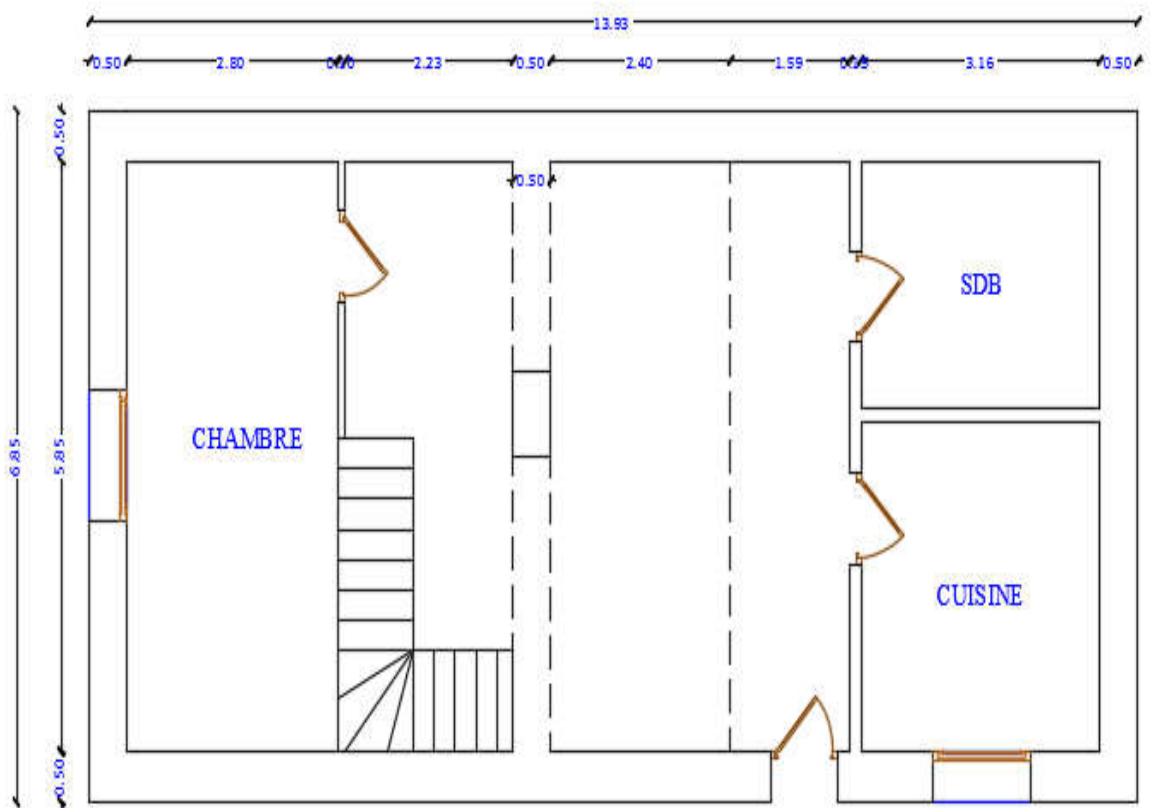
Plan de RDC construit avec pierre naturelle en 1949.
